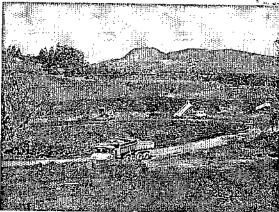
Obras na Variante do Maquiné – km 63+200 – Lote 03.
